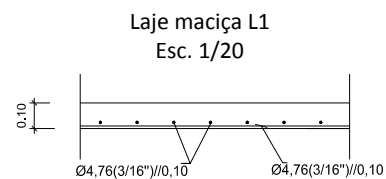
Pormenores de armaduras das vigas e laje do Mercado do Bolhão.
